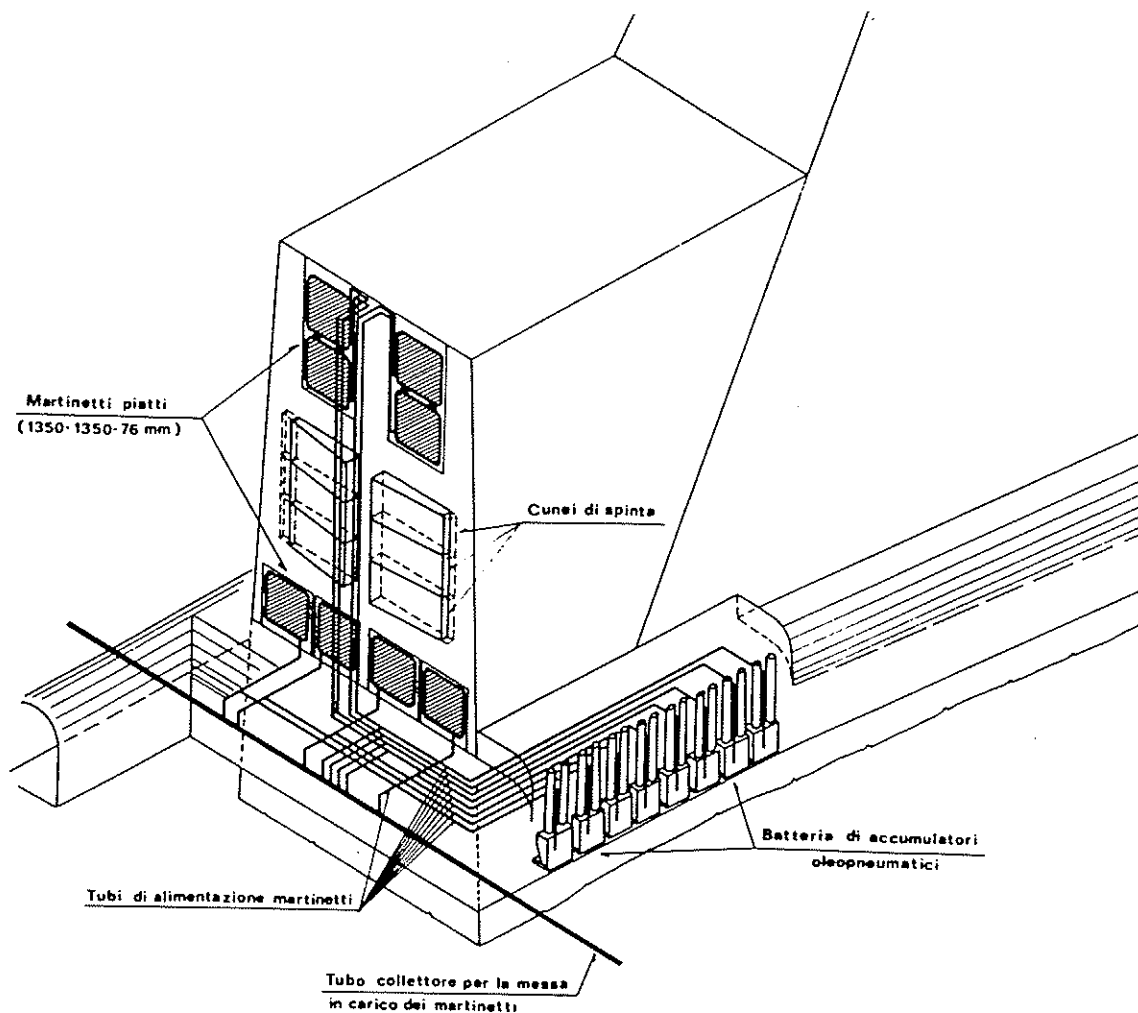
Schema tipo di installazione dei martinetti piatti su un concio tipo della diga di Corbara
